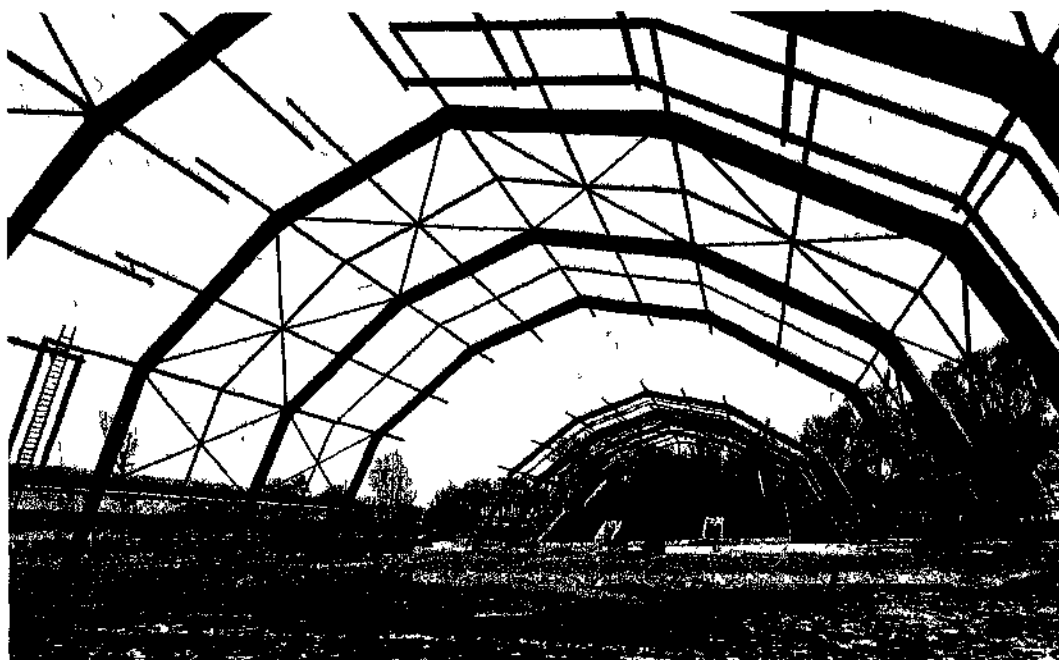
Festhallen-Zeltdach [62] mit den langverschieblichen zwei Mittelstücken, im Bau
